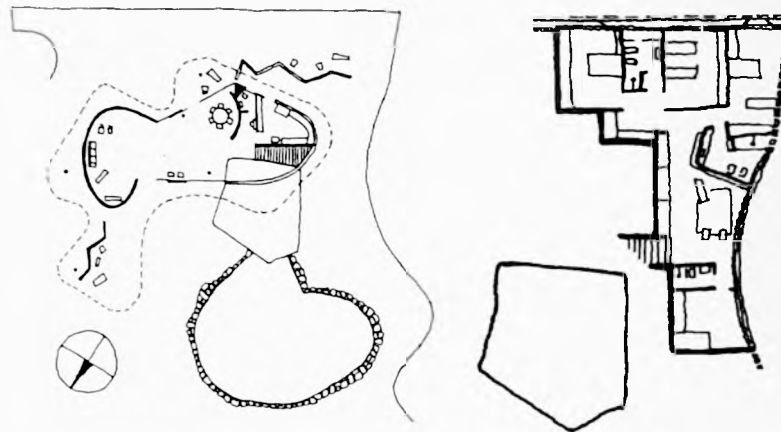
Croquis plantas pavimento térreo e interior casa de Canoas.
